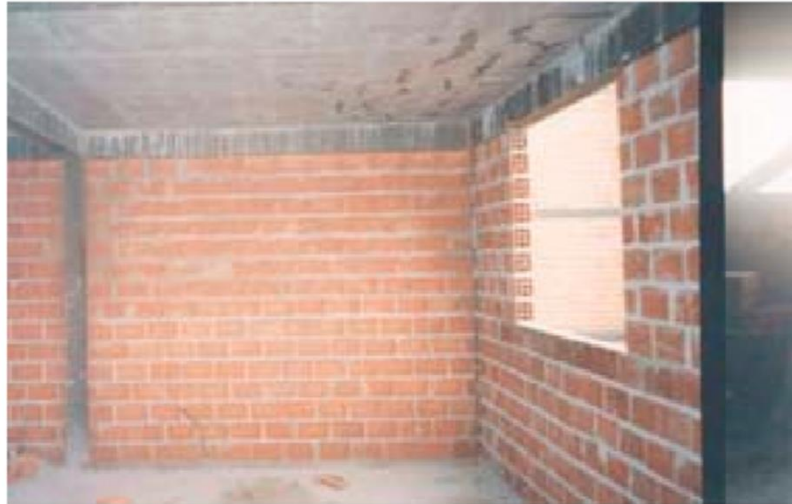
Detalhe da amarração entre a viga e o pilar e vedação das paredes.
